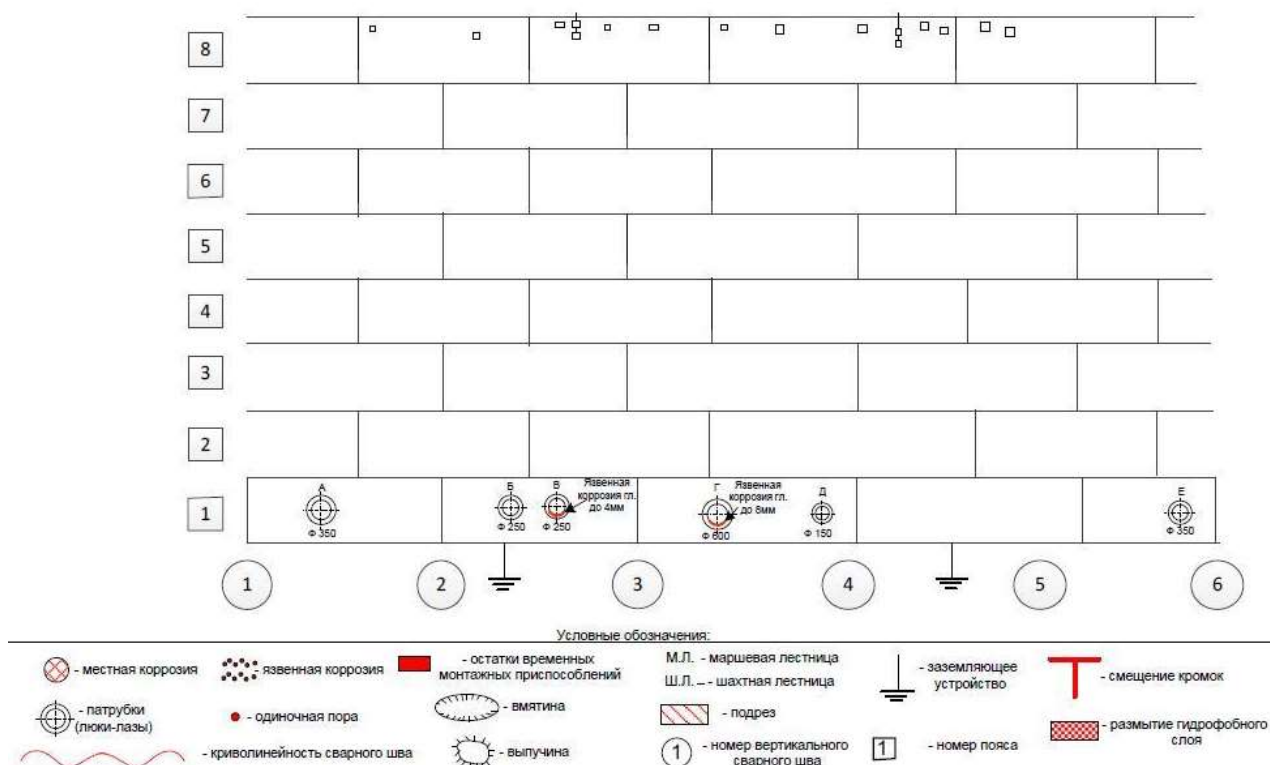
Схема развёртки наружной поверхности стенки РВС-2000
